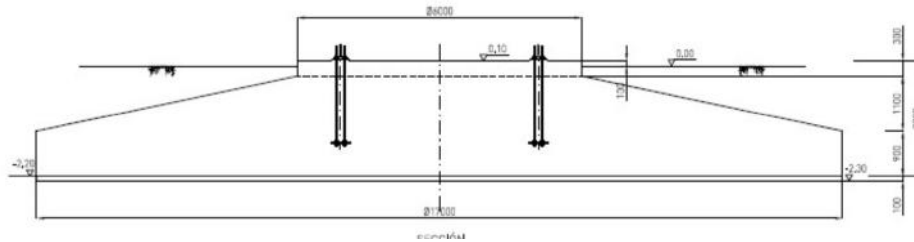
Prediseño cimentación de un parque eólico terrestre. Fuente: material facilitado por Consuelo Alonso
